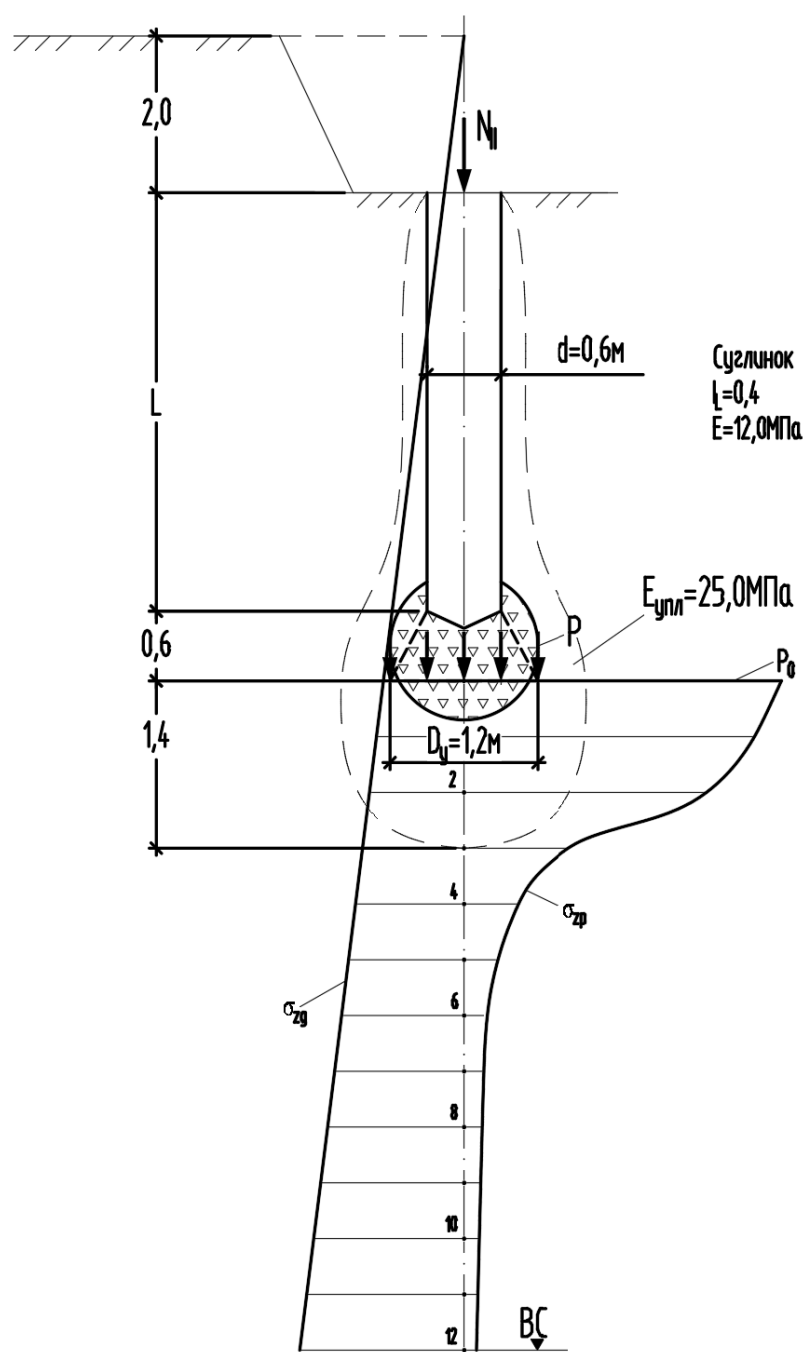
Схема расчета осадки свай в пробитой скважине
